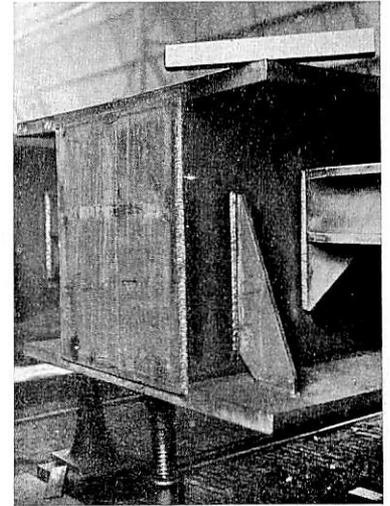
Ende der luftdicht geschweißten Kastenträger in der Mitte eines Gleises.
